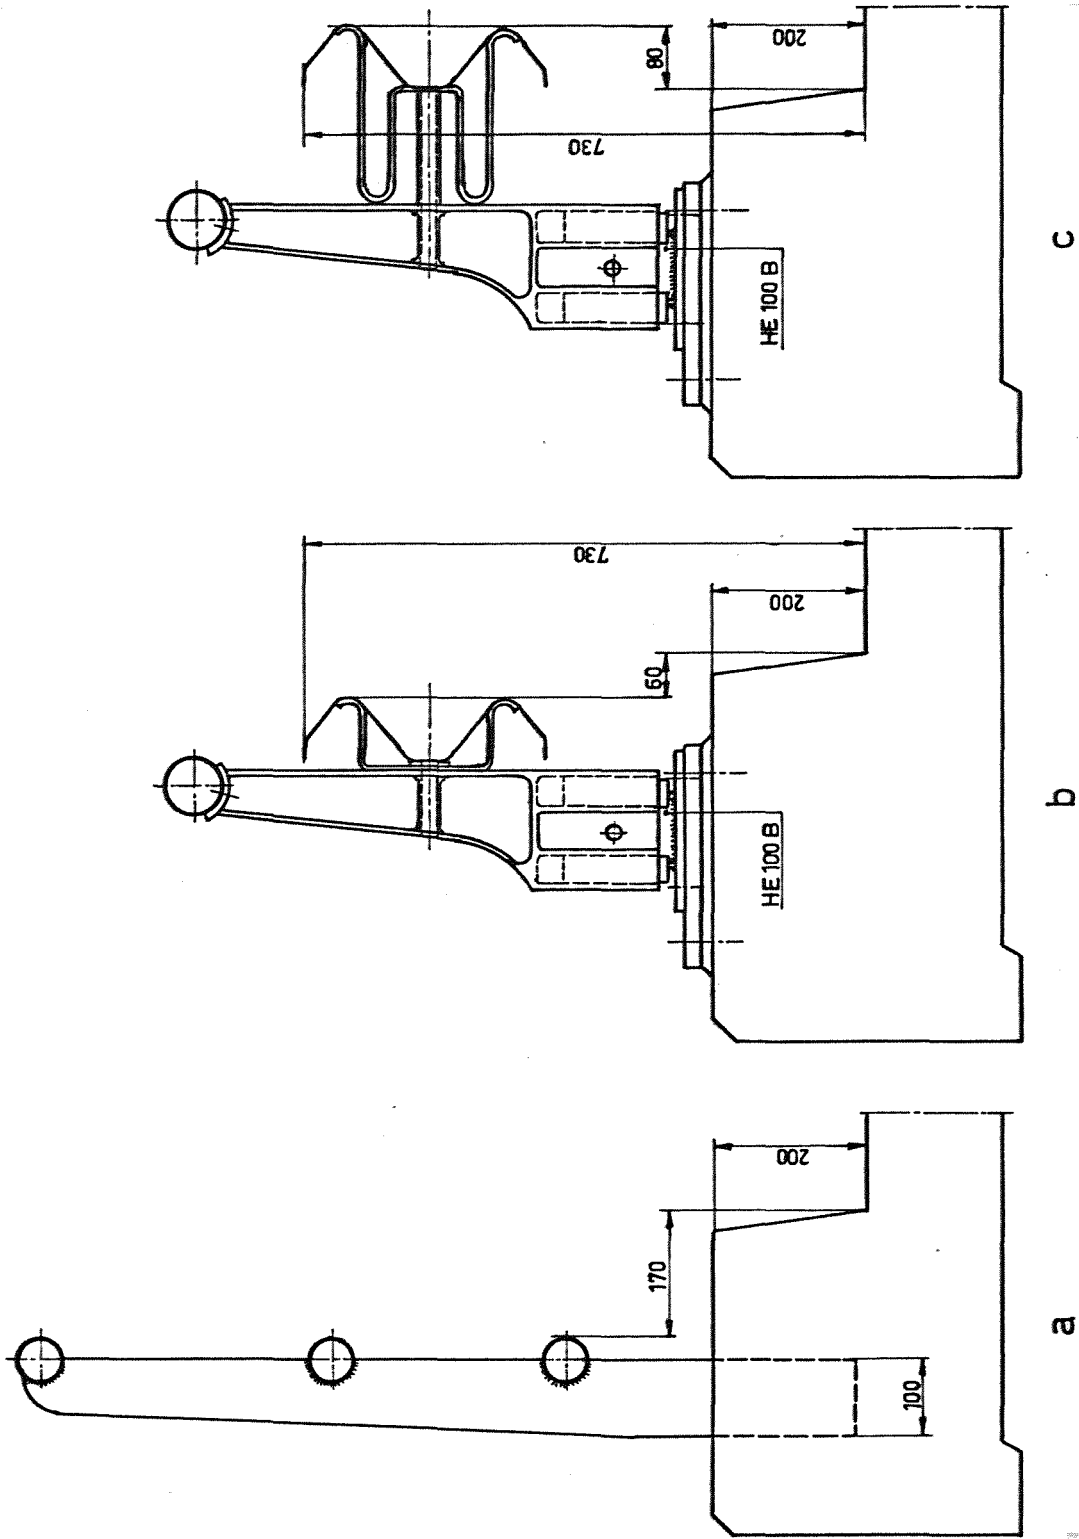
Globaal te verwachten uitbuigingen van de éenzijdig uitgebouwde beveiligingsconstructies.
